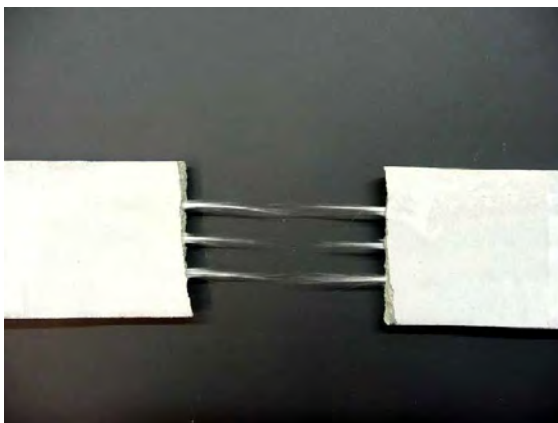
Betonprobekörper nach dem Zugversuch, VET ARG, 28 d, Standardlagerung
